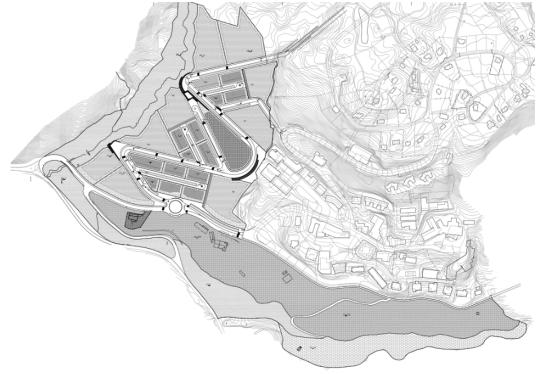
Plan Parcial original del Sector Estacho-Lanuza.
